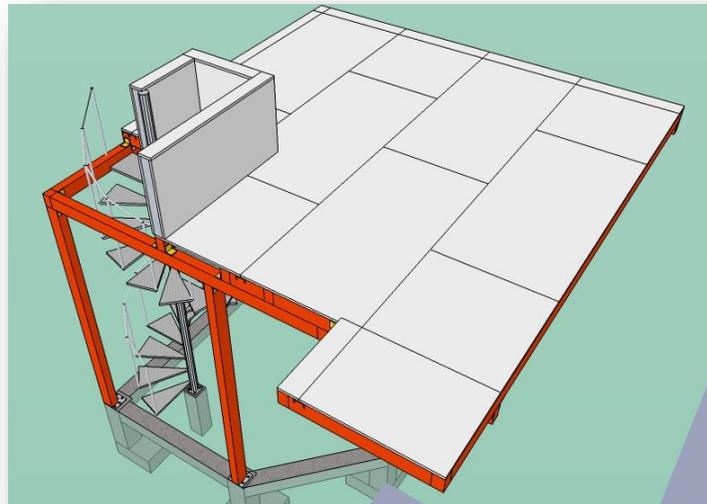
Vista de estructura metálica para soporte de entrepiso
